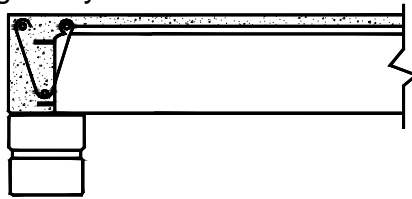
CP11 Apoyo de vigueta sobre muro (mínimo 0.05m)
